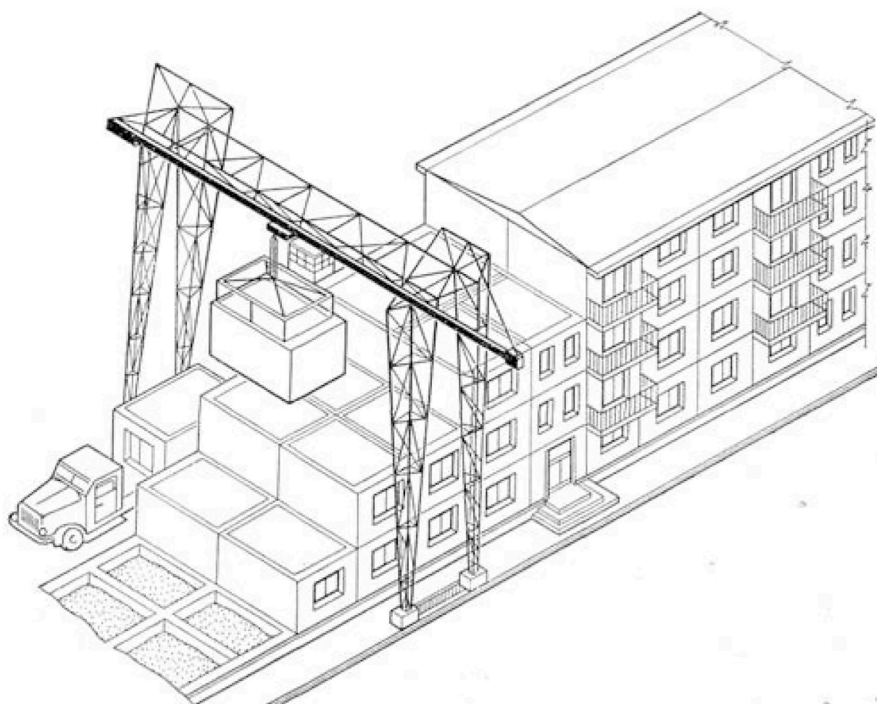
Монтаж жилого дома из объемных блоков [4]
